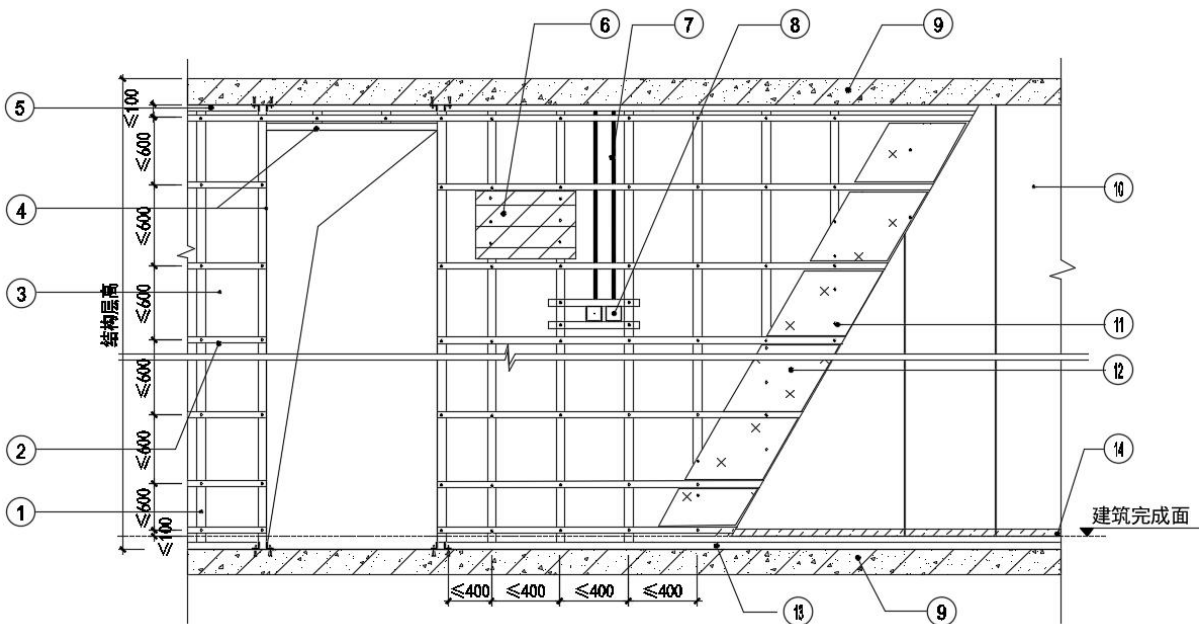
骨架隔墙系统构造示意图（立面图）
